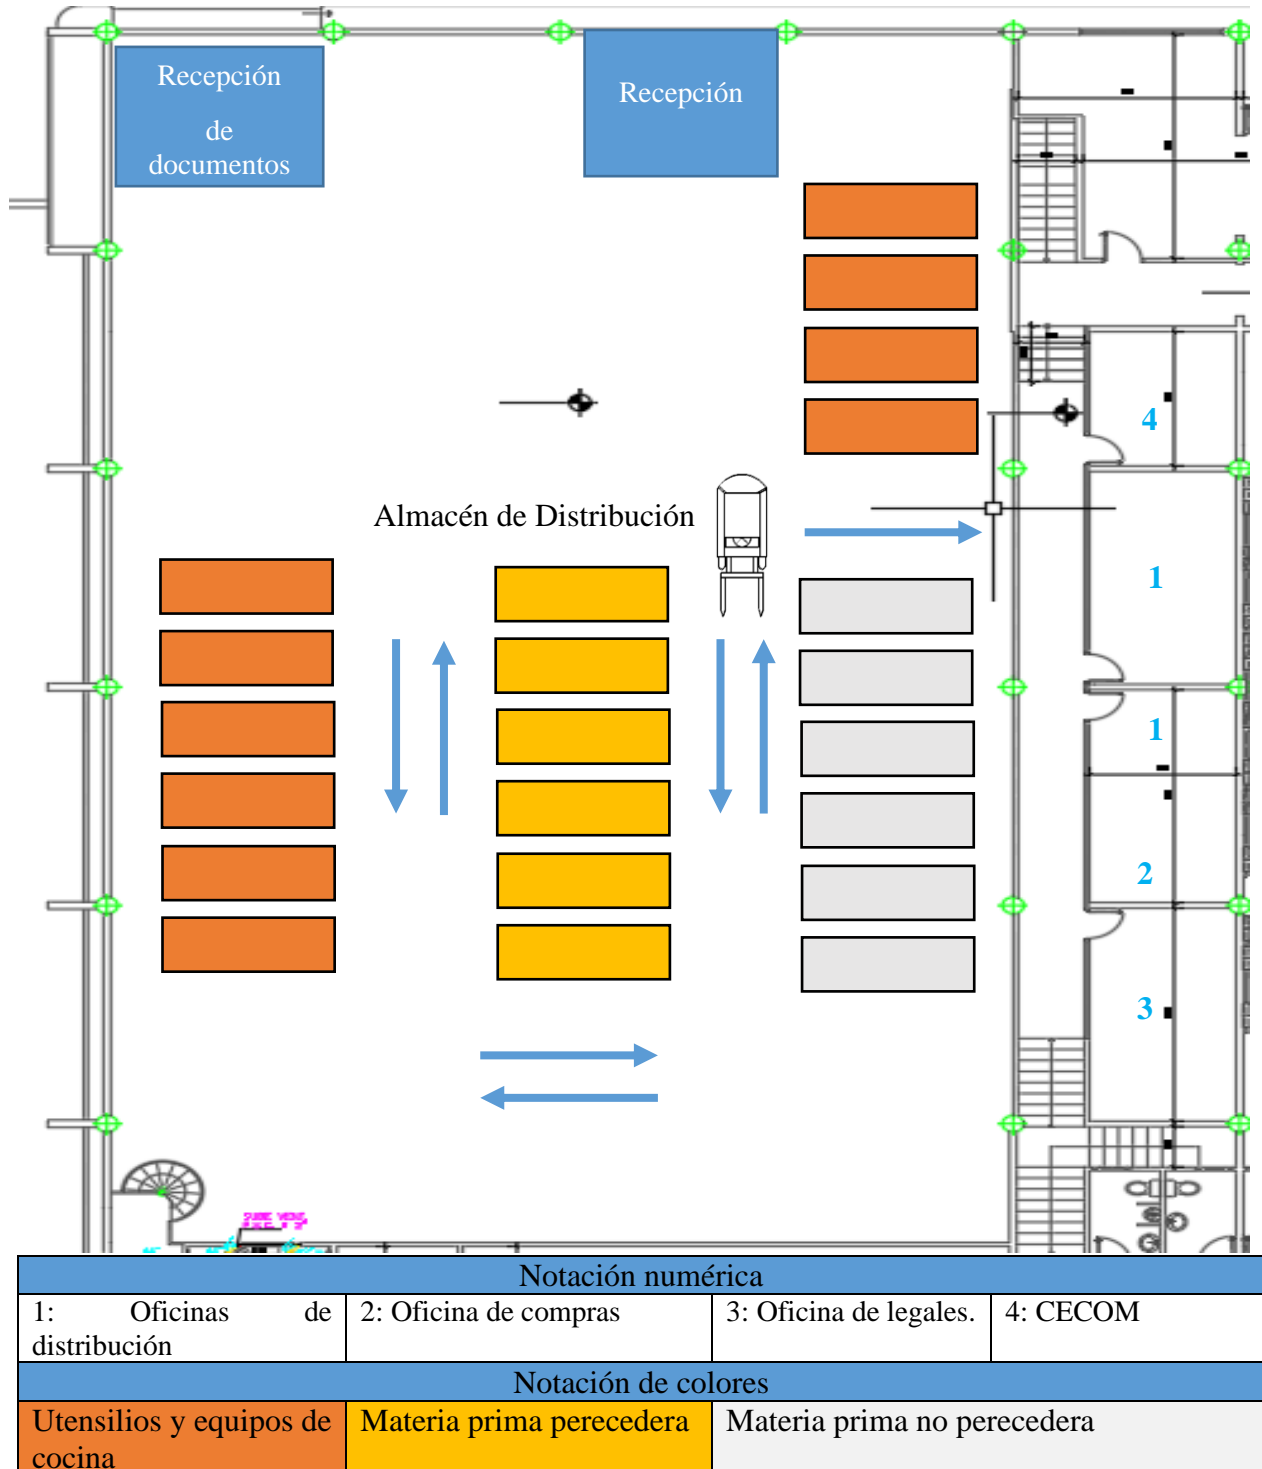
Vista de áreas de almacenamiento de distribución planta alta
